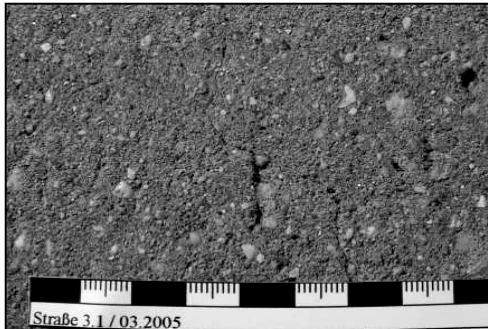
Straßenbeton 3.1: Straßenoberfläche mit Längsriss im Alter von 10 Jahren
